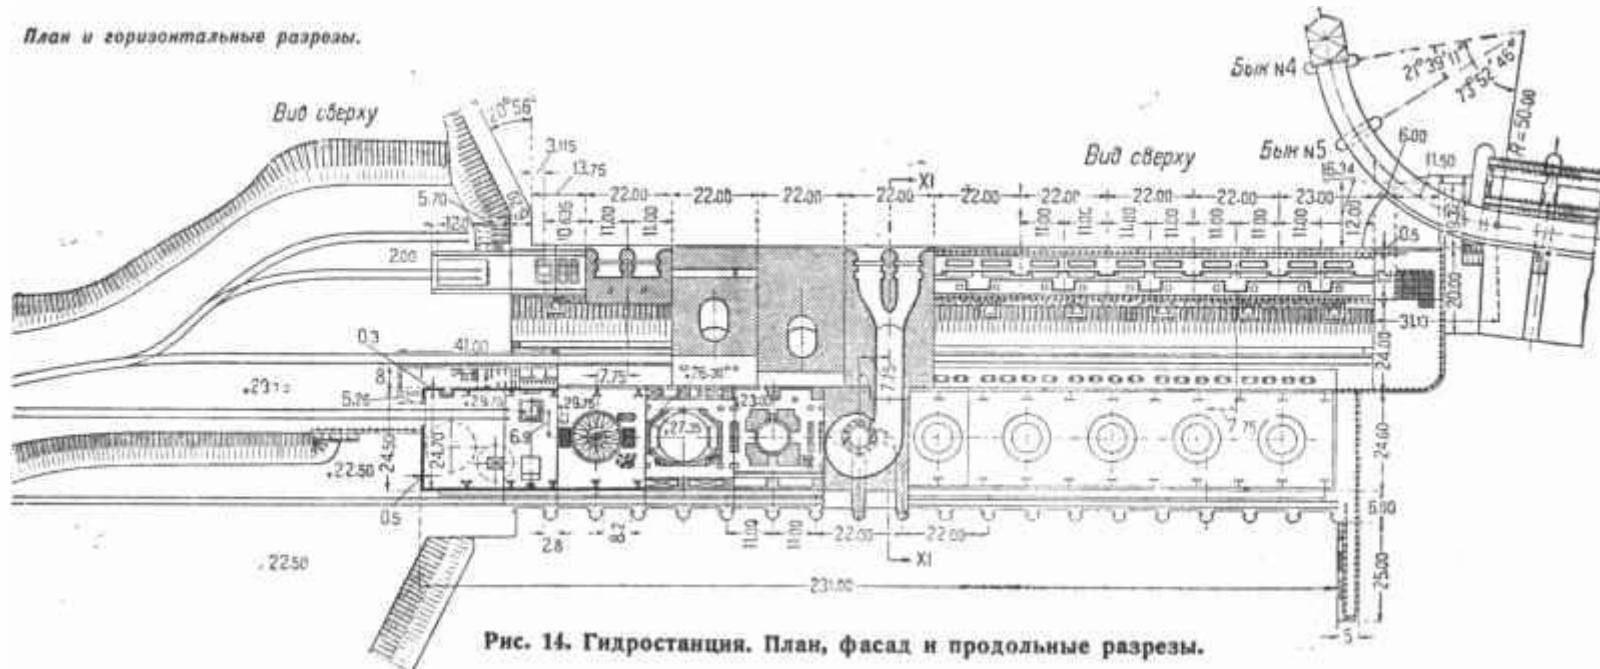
Гидростанция. План, фасад и продольные разрезы.
